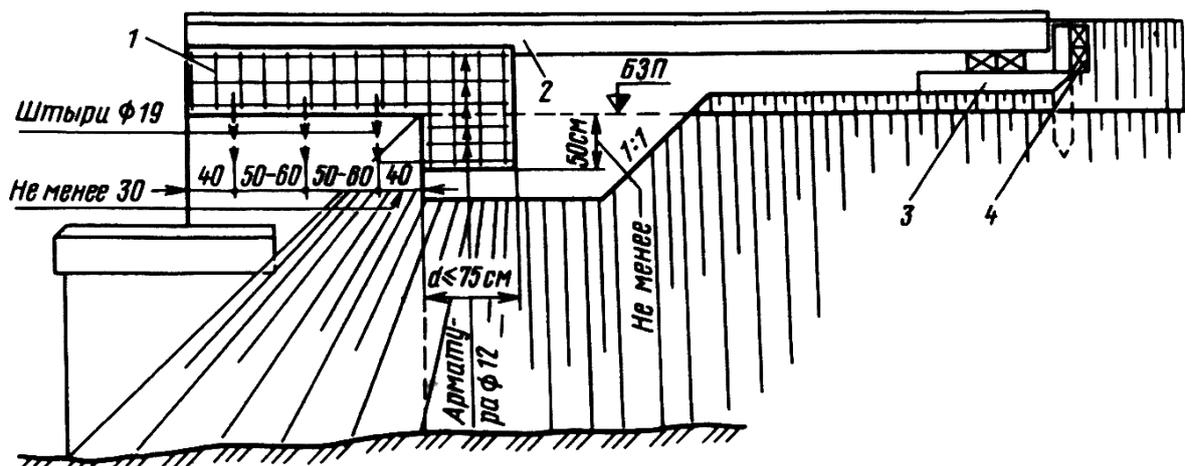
Удлинение обратных стенок устоя: 1 – железобетонная консоль (крыло);
